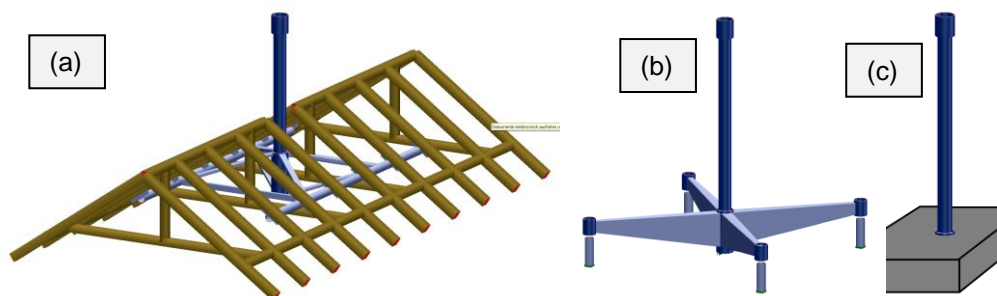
Mastkonstruktion (a) Giebeldach (b) Flachdach (c) freistehender Mast+Fundament
